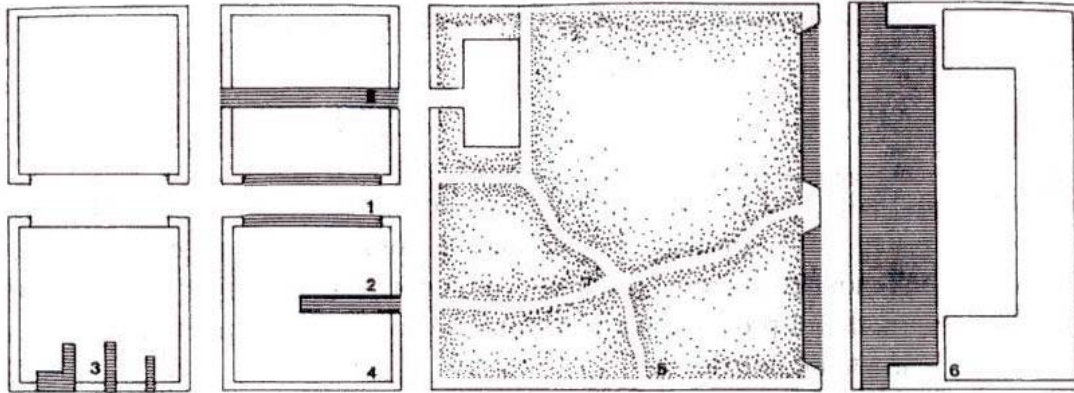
Disposición de pavimentos celulares. 1.- Estacionamientos, 2.- Pasajes y calles, 3.- Accesos vehiculares, 4.- Manzanas de la zona urbanizada, 5.- Áreas verdes, 6.- Comercio.
